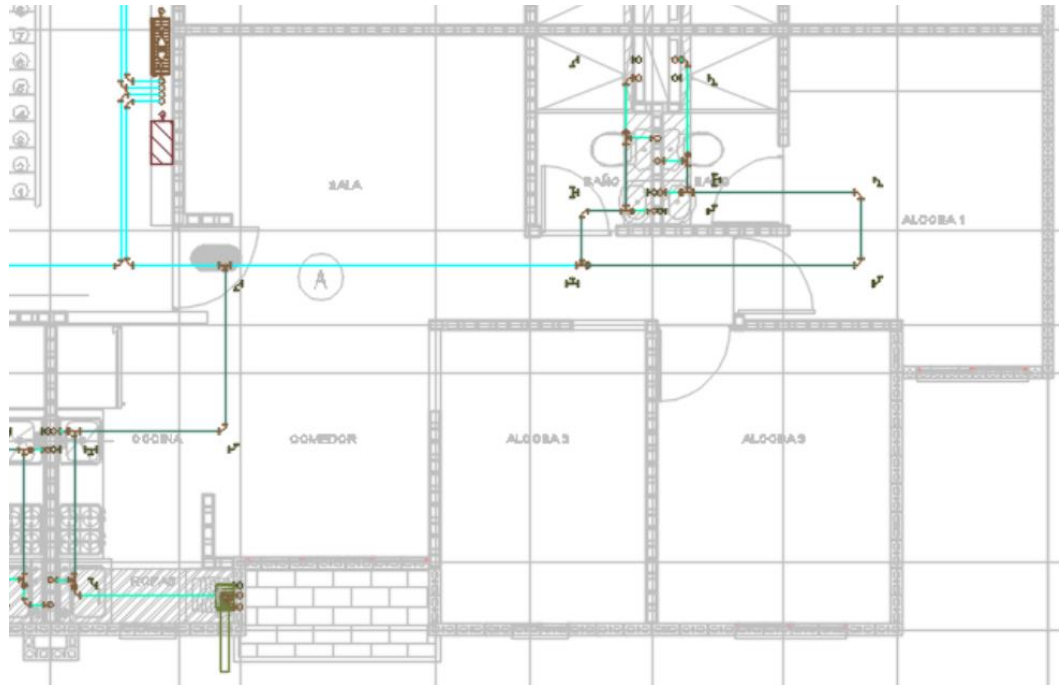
Planta arquitectónica apartamento tipo con red trazada
